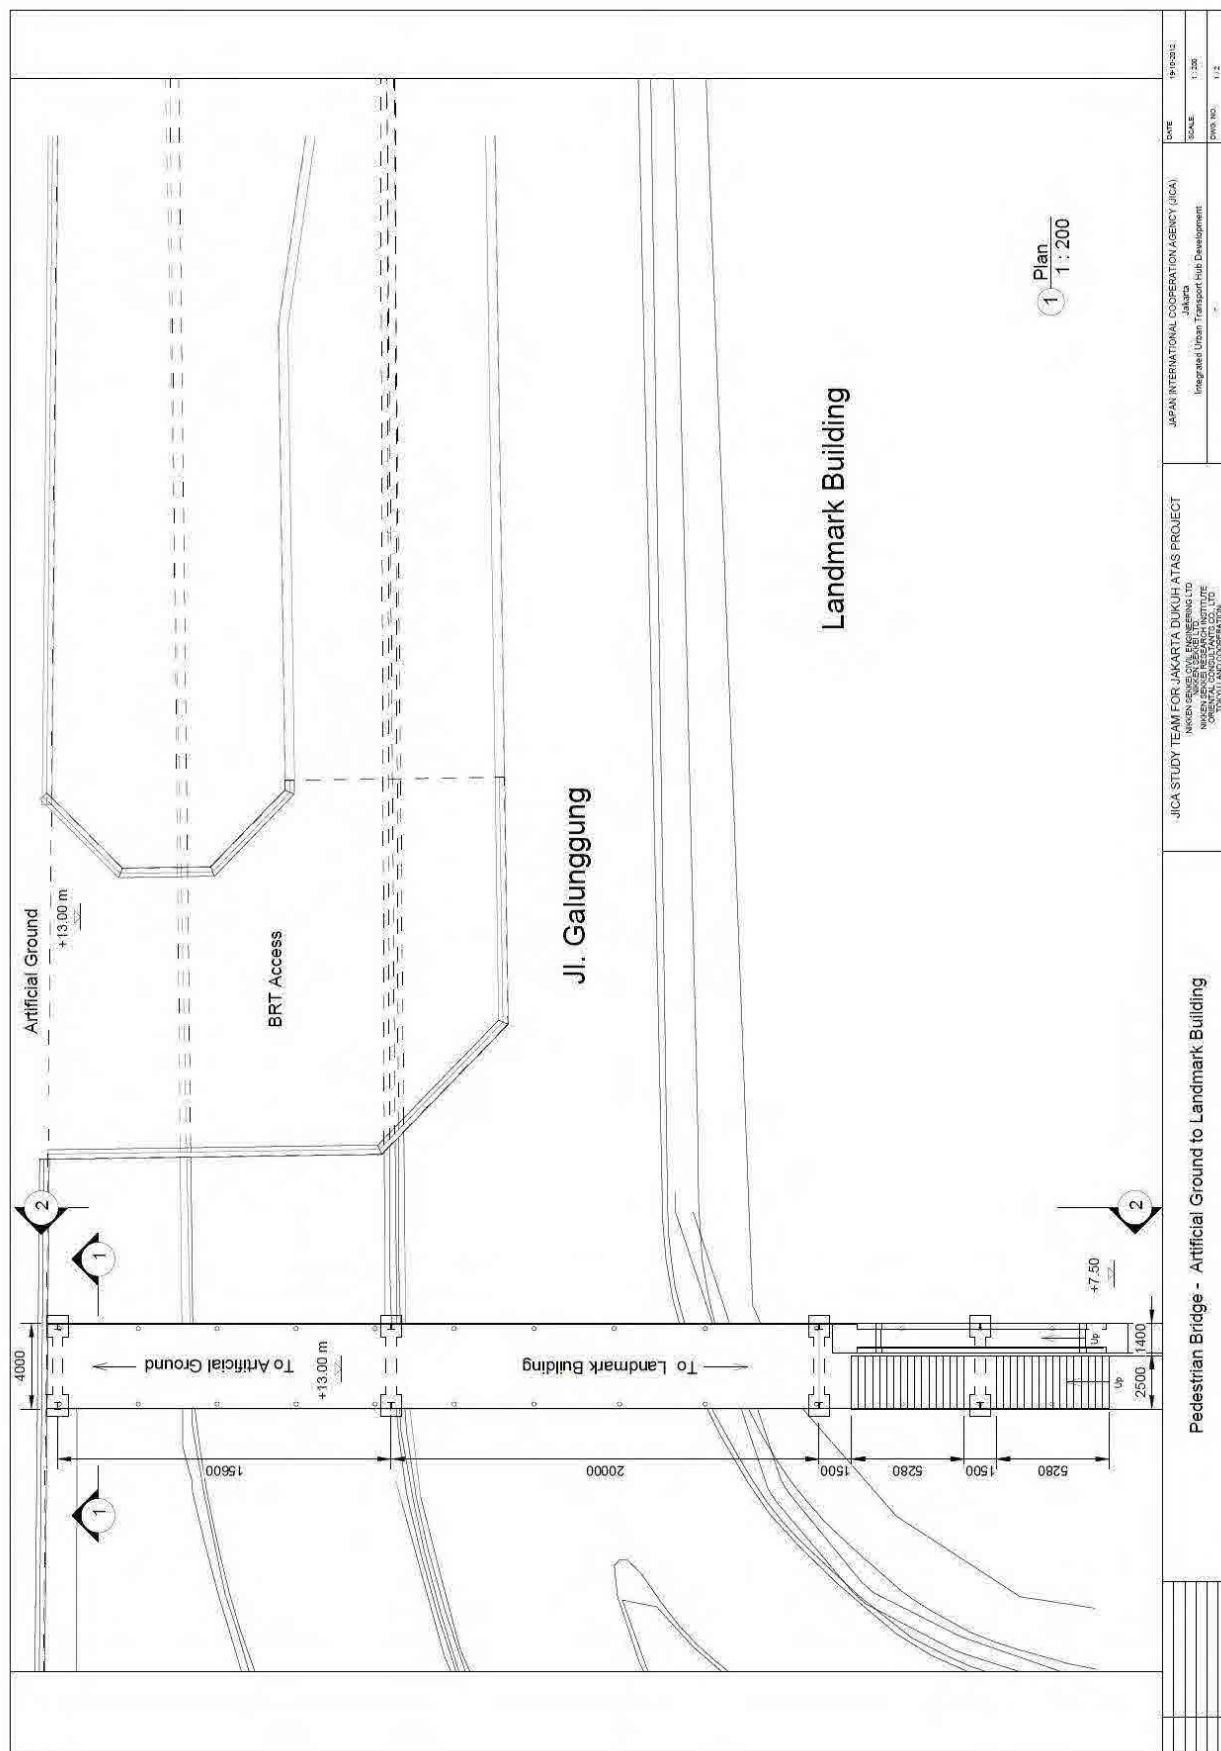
東側人工地盤-南東ブロック連絡通路平面図
